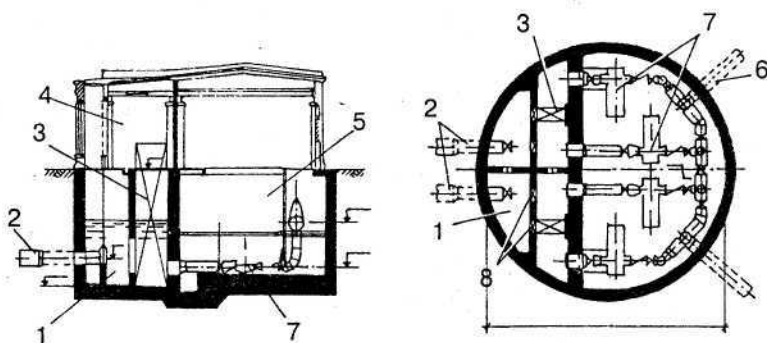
Схема водоприемника руслового типа, совмещенного с насосной станцией: 1 — водоприемно-сеточный береговой колодец; 2 — самотечные линии; 3 — вращающиеся сетки; 4 — наземный павильон; 5 — насосная станция; 6 — напорный трубопровод; 7 — насосы; 8 — окна на случай забивки сетки шугой
